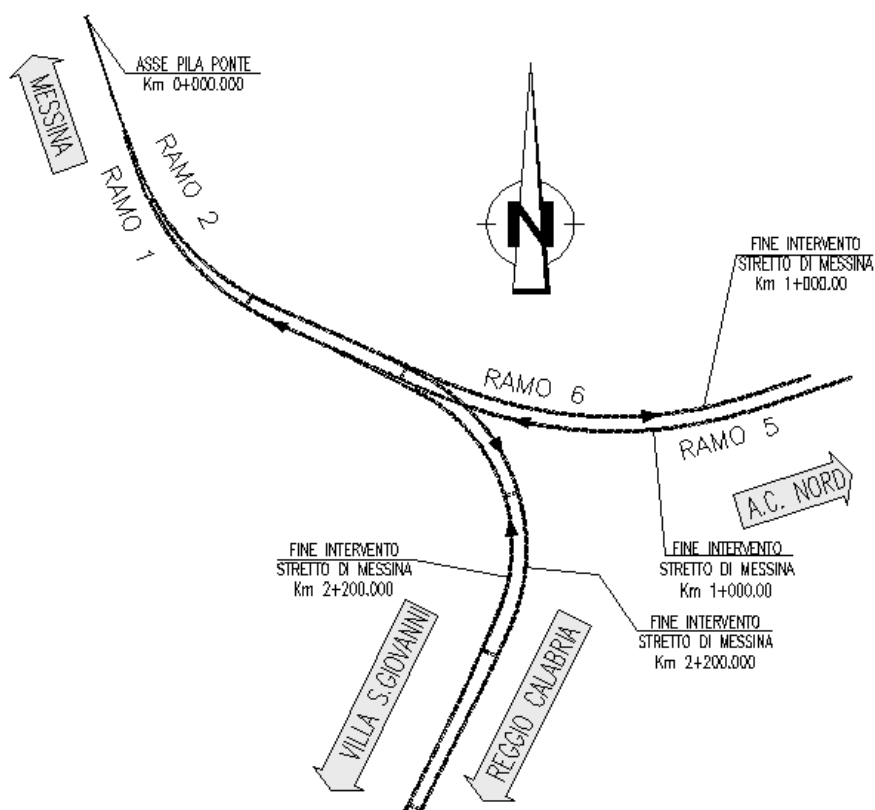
Schema planimetrico delle gallerie ferroviarie
